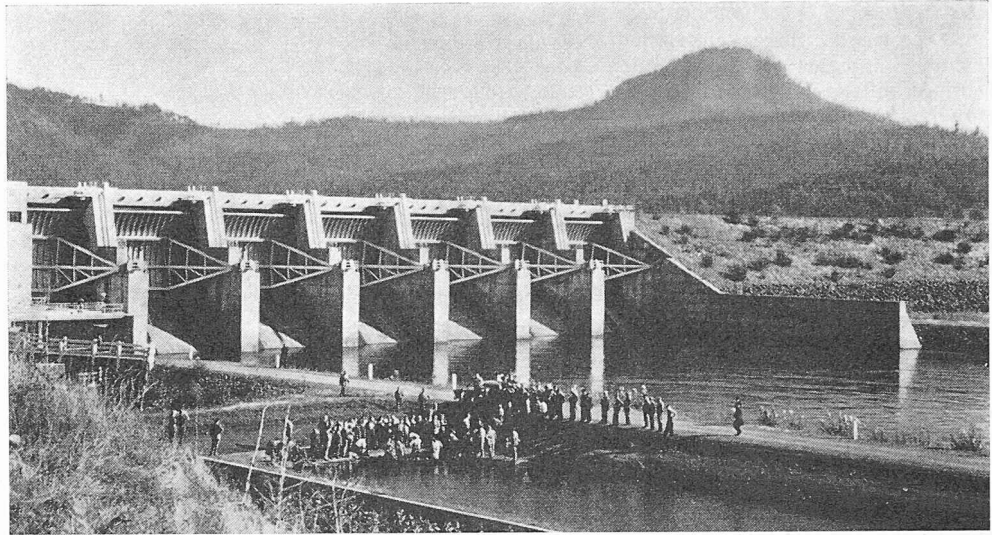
Dexter-Damm am Middle Fork Willamette River mit siebentorigem Wehr für 7500 m<sup>3</sup>/s
